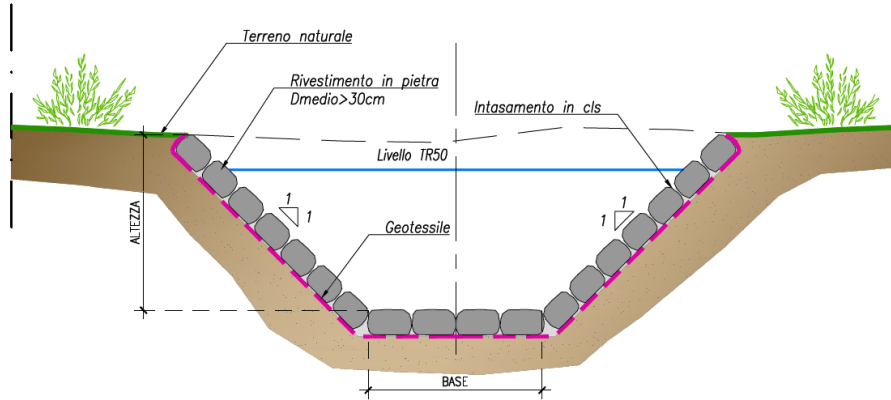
Sezione tipo fosso rivestito in pietrame intasato con cls
